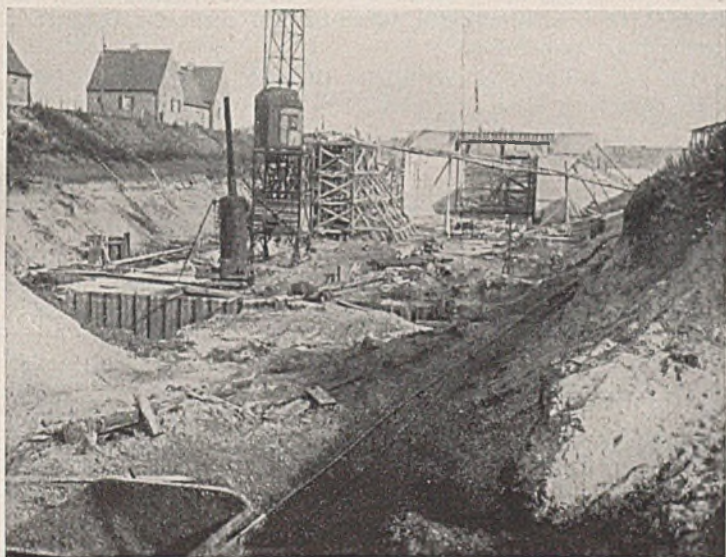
Baugrube: Unterhaupt betoniert, Unterhauptbrücke eingeschalt.
